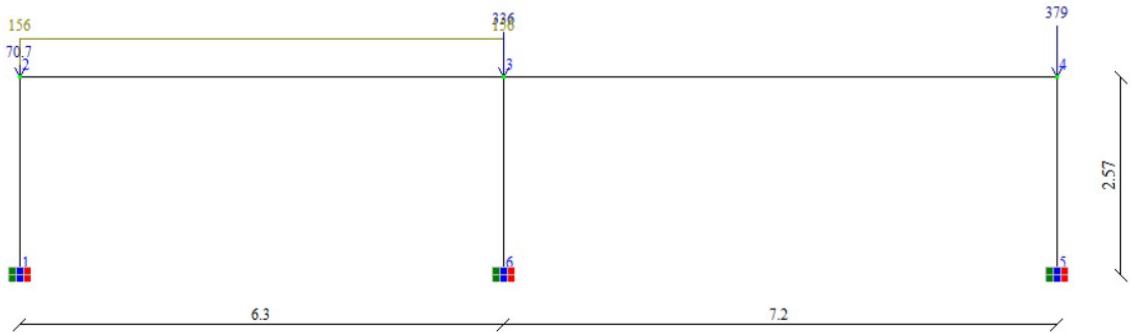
Розрахункова схема для 2-го варіанту навантажень
